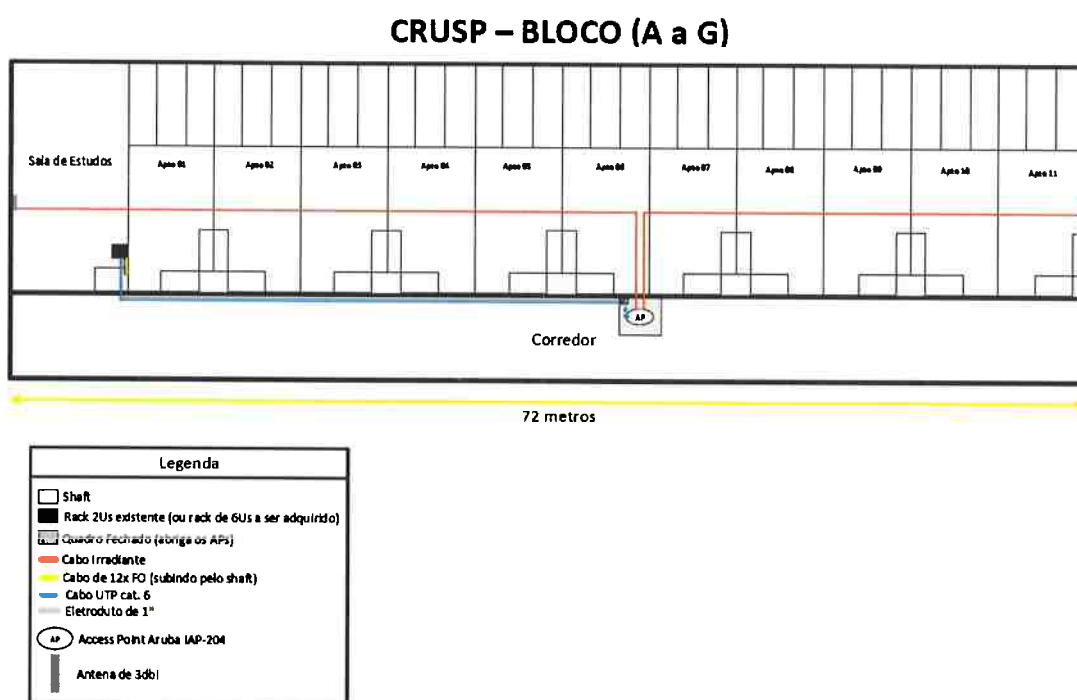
planta dos pavimentos que compõem o CRUSP.
